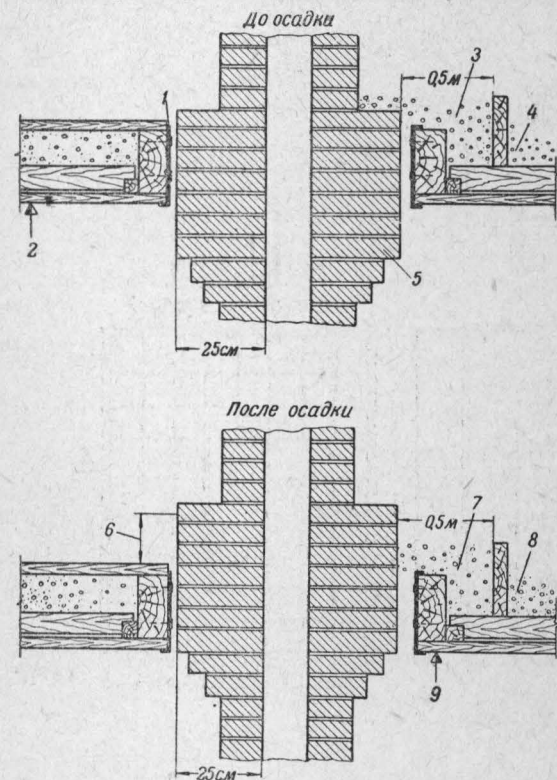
Горизонтальная разделка у дымового канала в чердачном перекрытии (до осадки перекрытия и после осадки):
